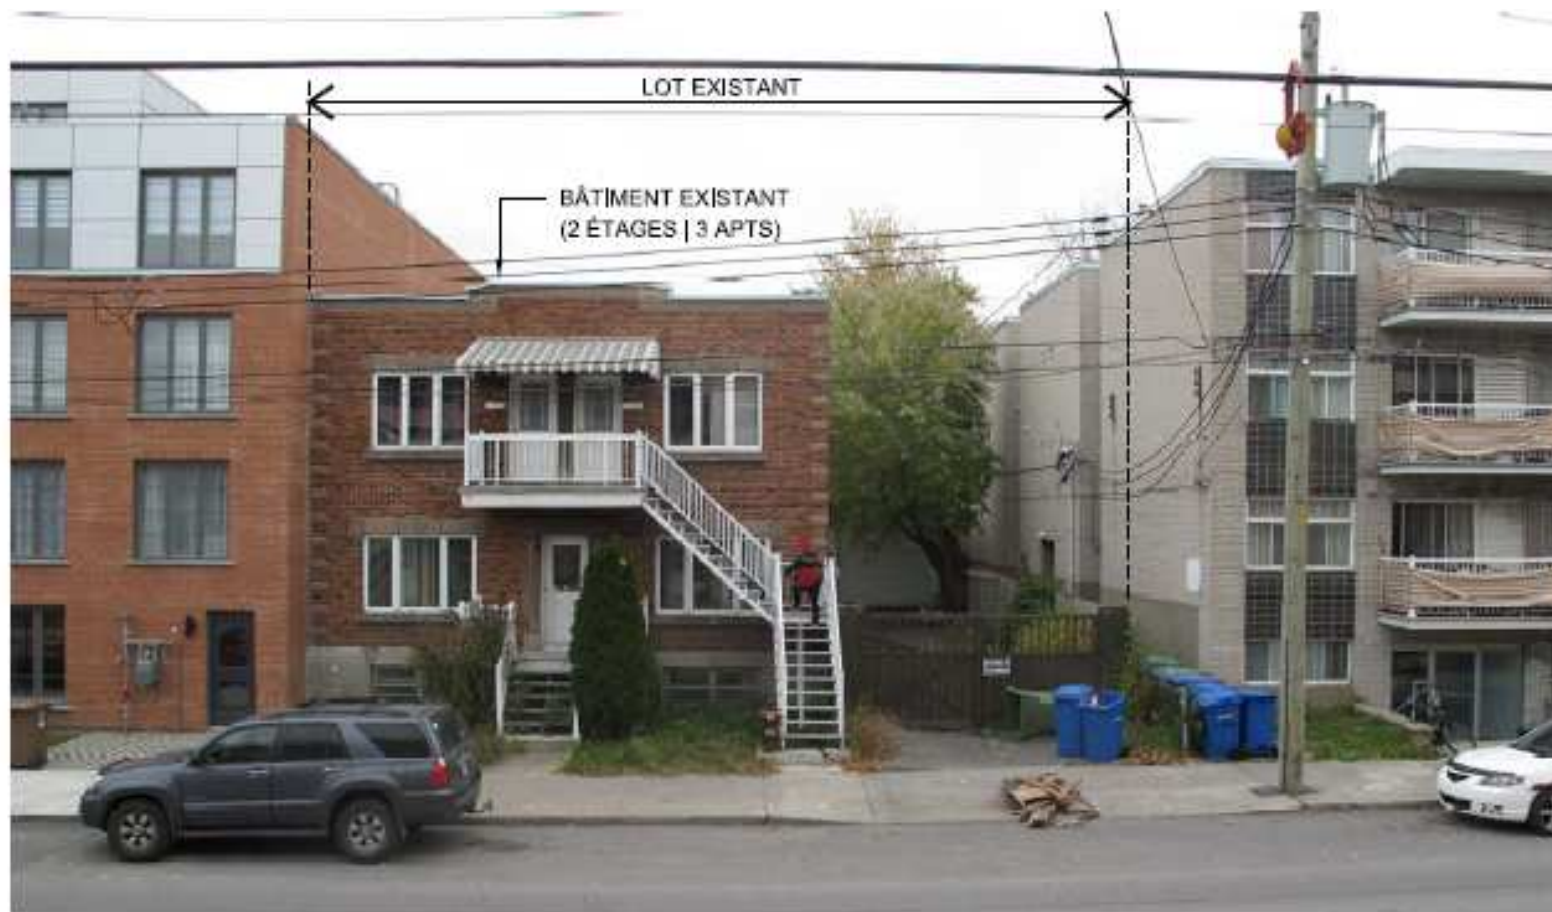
FAÇADE AVANT (RUE BANNANTYNE)
